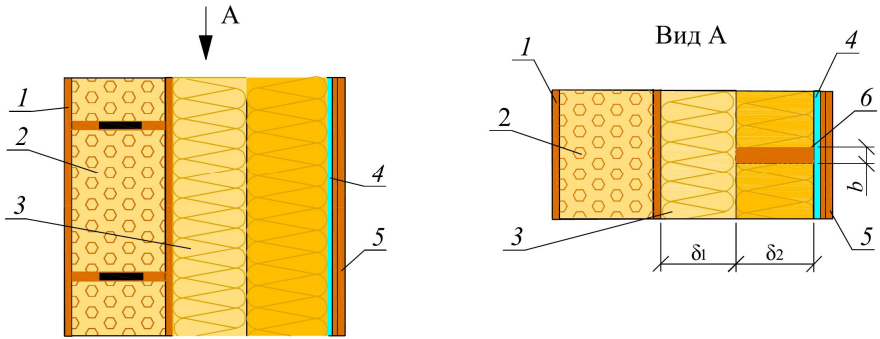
Конструкция наружной стены из легких керамических блоков с внутренней тепловой изоляцией: 1 – штукатурный слой; 2 – легкие керамические блоки; 3 – тепловая изоляция; 4 – пароизоляция; 5 – внутренняя обшивка; 6 – рейка 48 мм, с шагом 0,6 м
